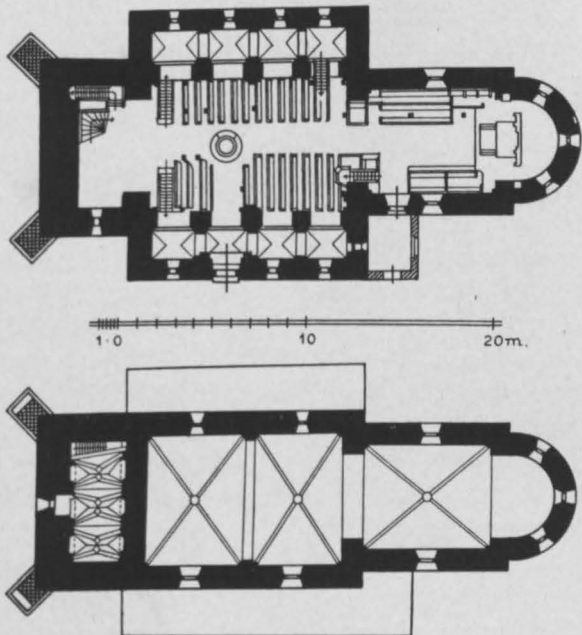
Lindena. Grundrisse der Kirche.
